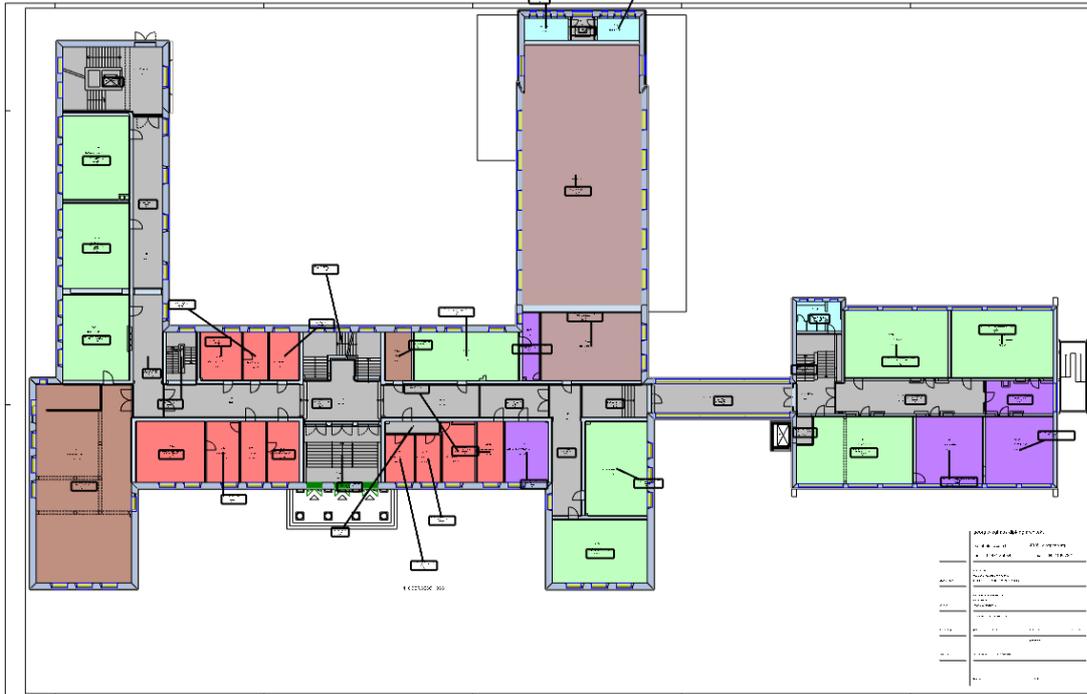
Grundriss 1.OG, zoniert
